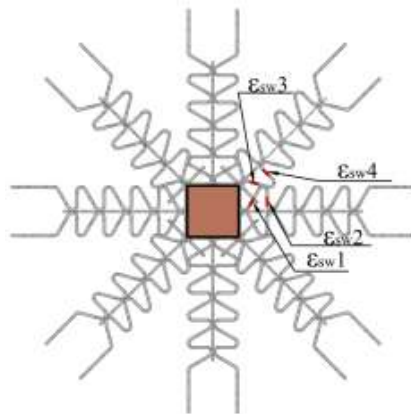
Disposição dos ϵ_{sw3} e ϵ_{sw4} nas armaduras de cisalhamento da laje L3
